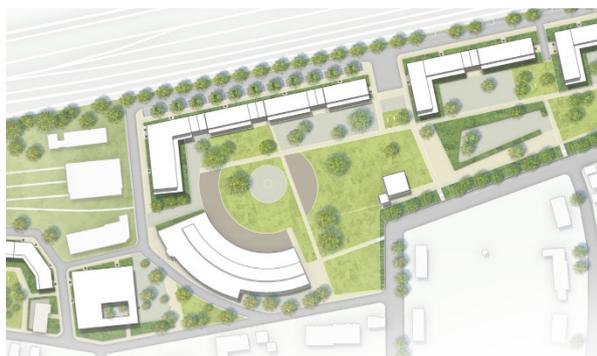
Rahmenplan „Bahnhofsumfeld Buchholz“ (Ausschnitt Lokschuppen und Umgebung)
